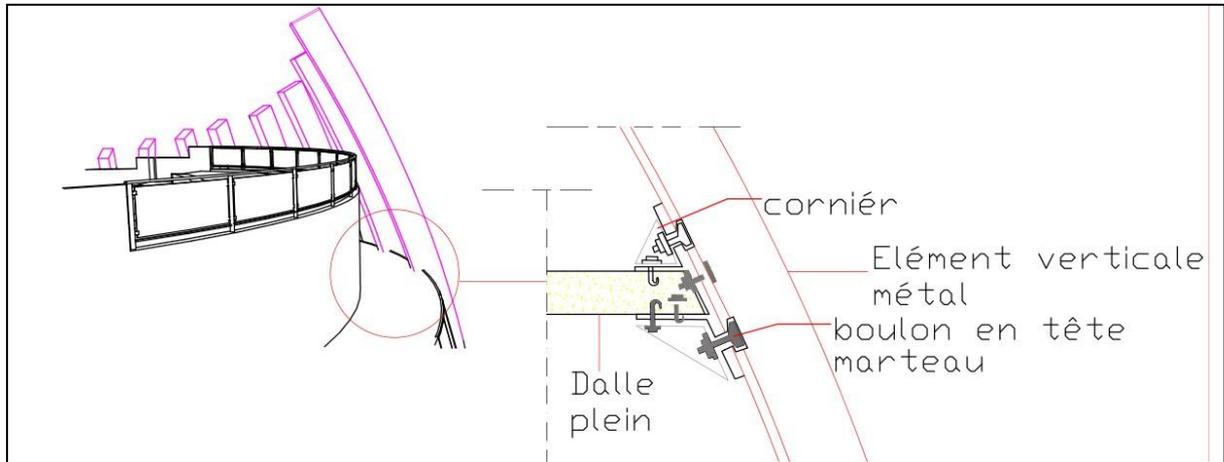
Vue sur la fixation de l'élément en métal avec la dalle pleine
